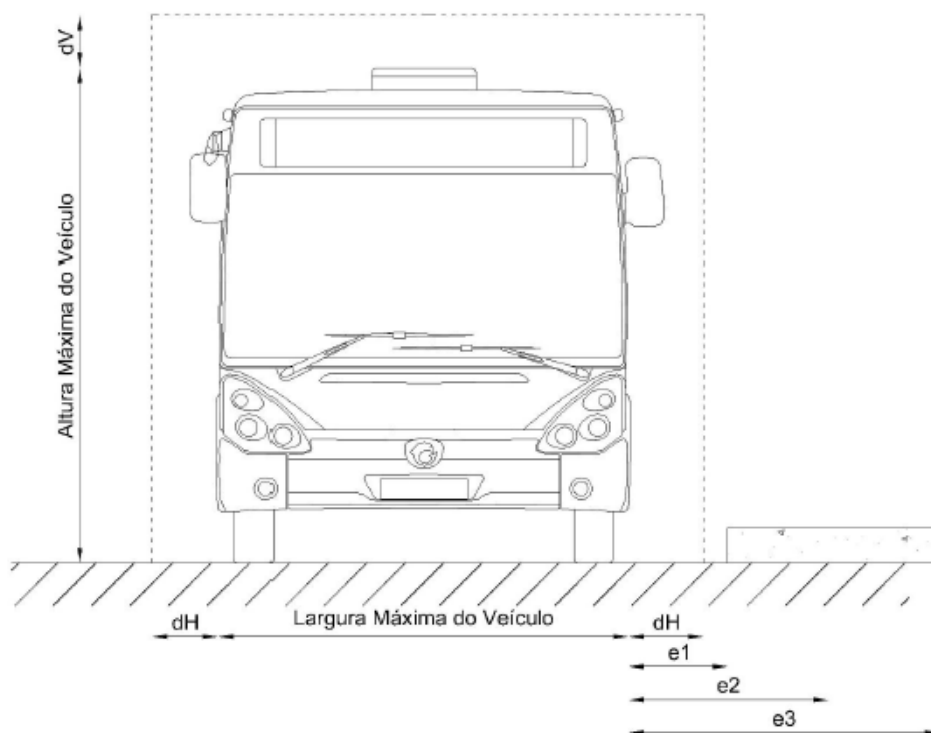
PERFIL TRANSVERSAL TIPO DE UM VEÍCULO PESADO DE PASSAGEIROS
